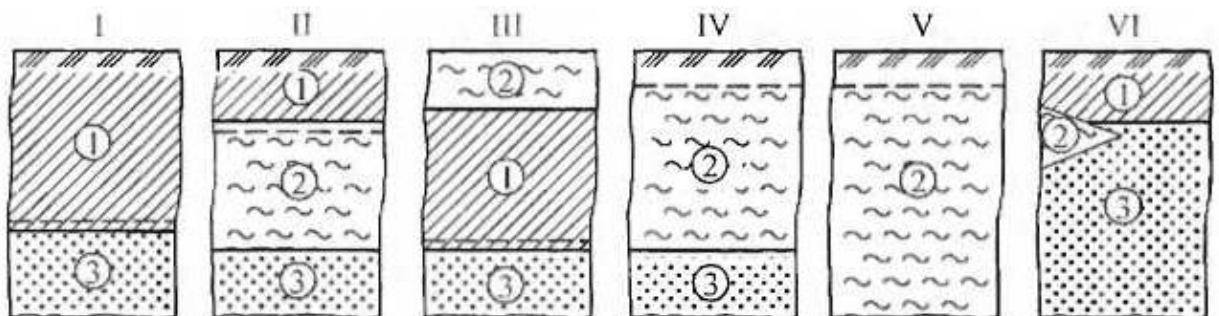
Схеми типових напластувань ґрунтів (I - VI): 1 – придатні; 2 – слабкі; 3 – щільні.
